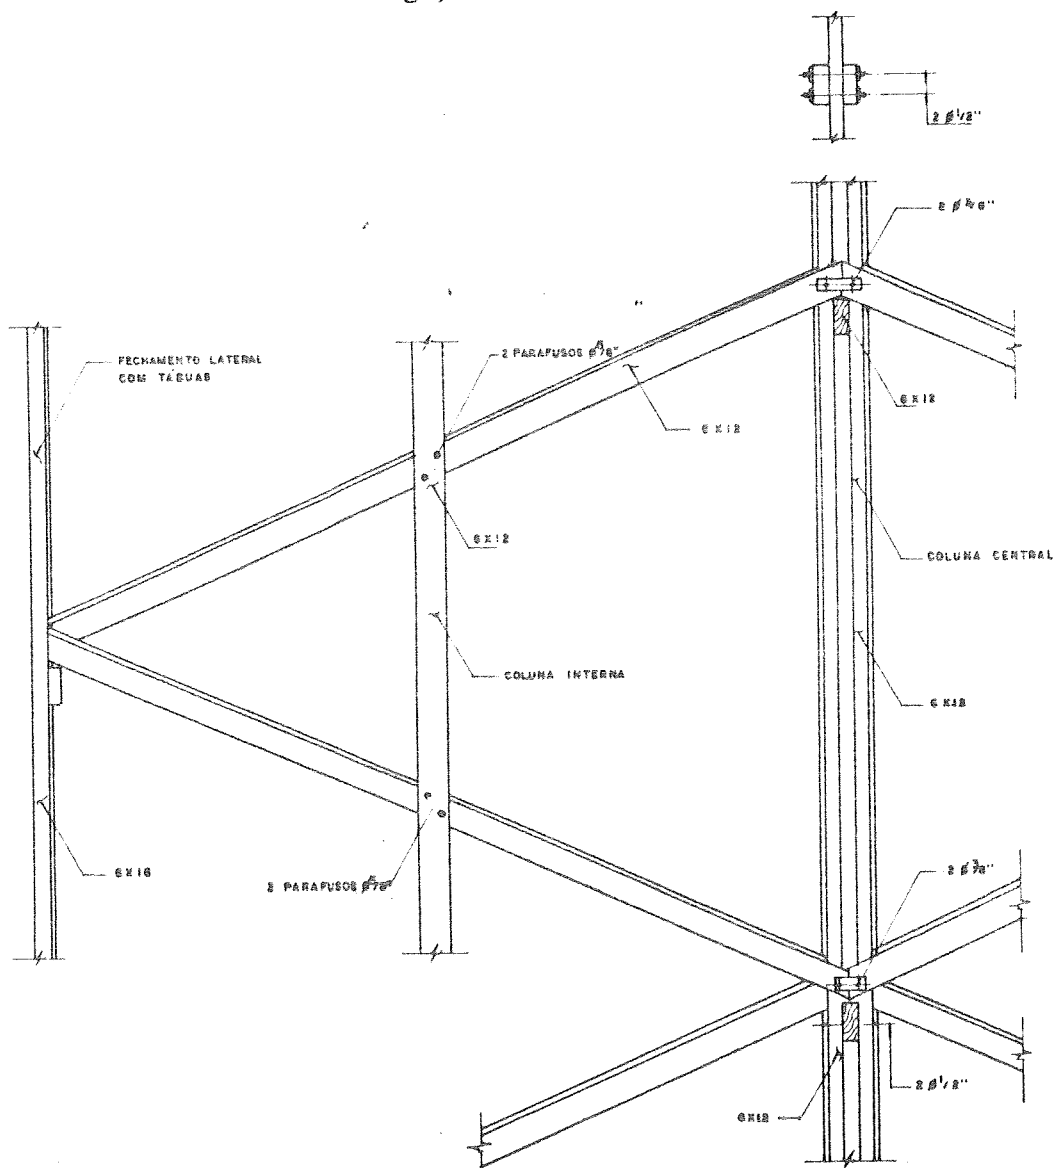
Detalhes das ligações entre - rampa-colunas, rampa-viga, viga-coluna.
